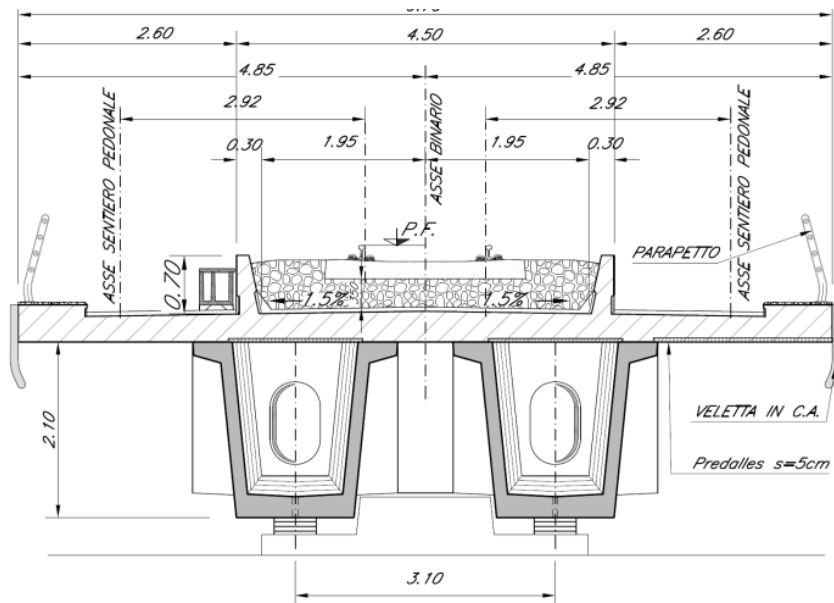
Sezione trasversale campate in c.a.p. L=25 m
